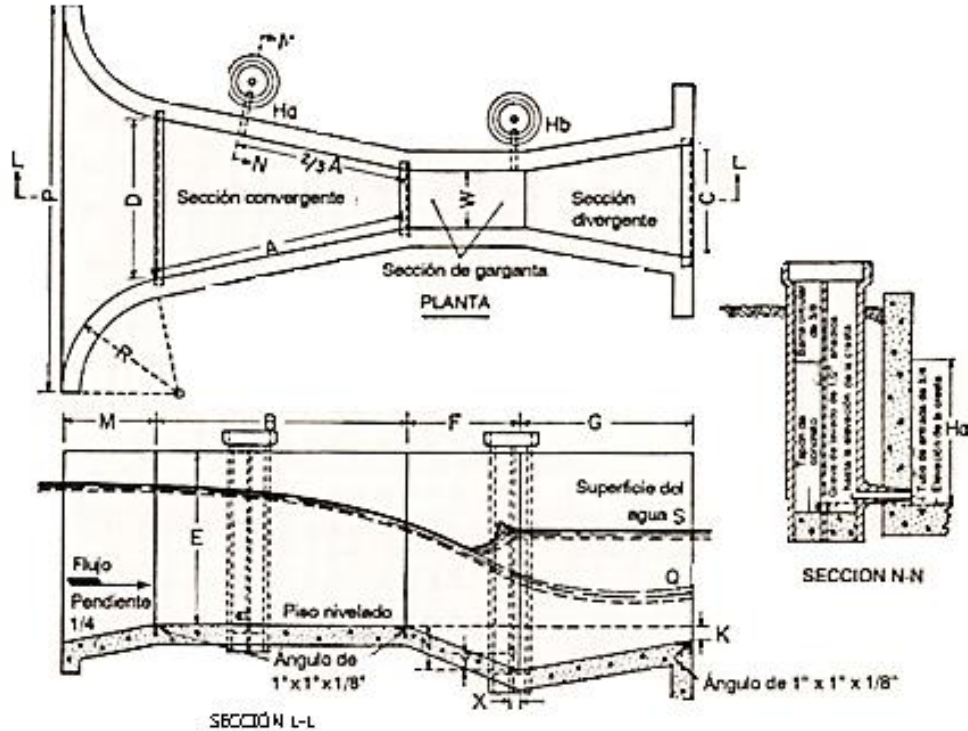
Vista en Planta y corte transversal L-L de una Canaleta Parshall.
